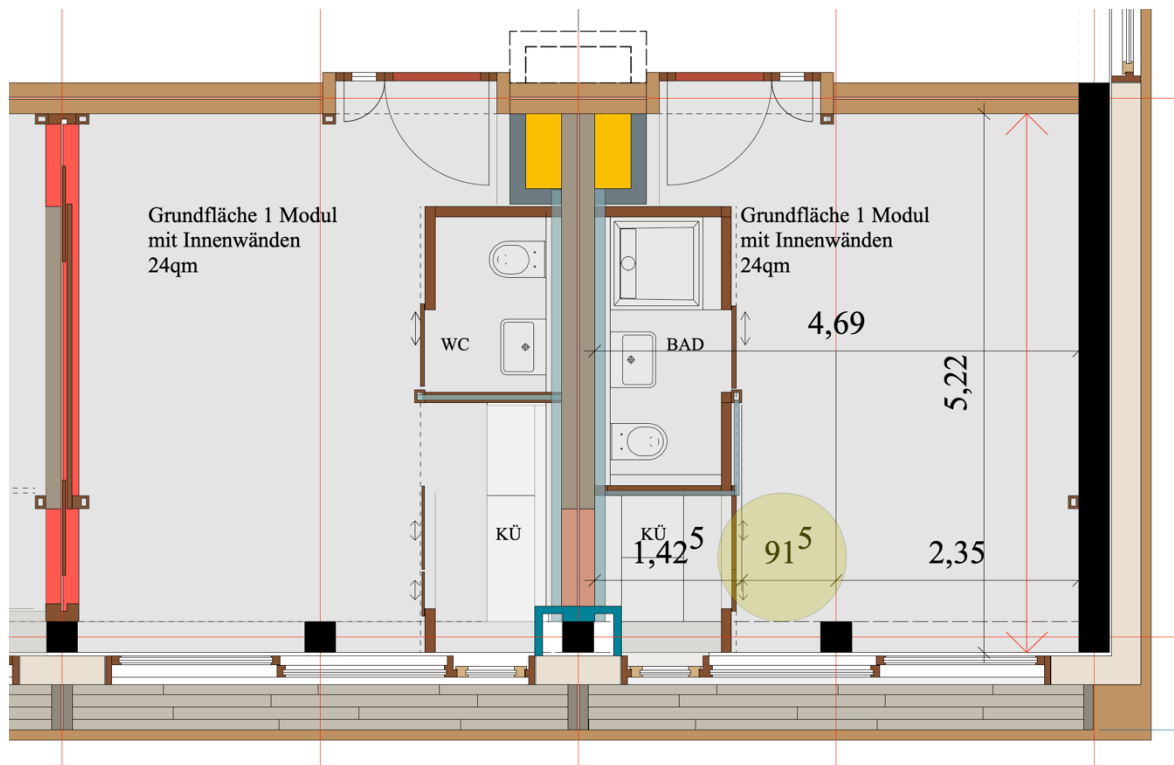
Überprüfung der Grundrissgeometrie der kleinstmöglichen Einheit bei Untersuchungsobjekt 2
